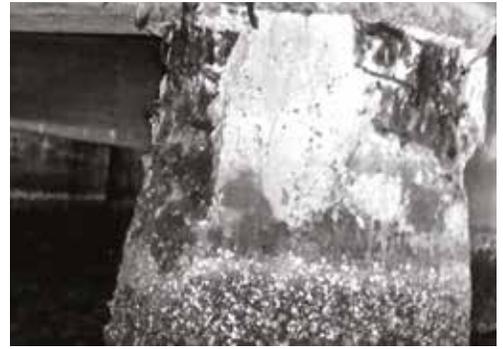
Elemento de concreto reforzado dañado por acción del agua de mar.
